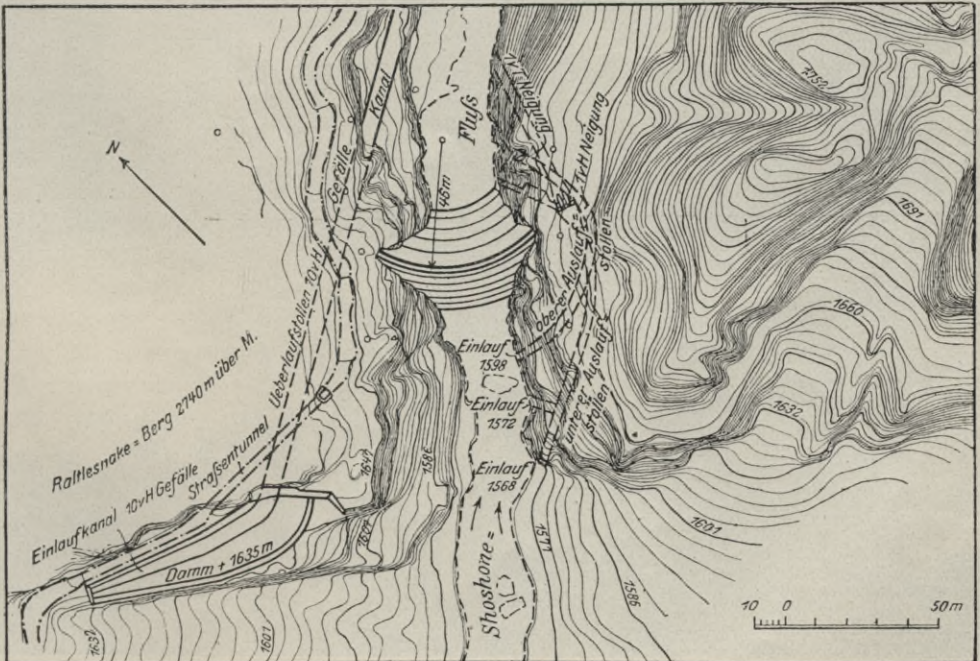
Die Shoshone-Talsperre (Wyoming, Nordamerika) mit ihren Betriebseinrichtungen.
